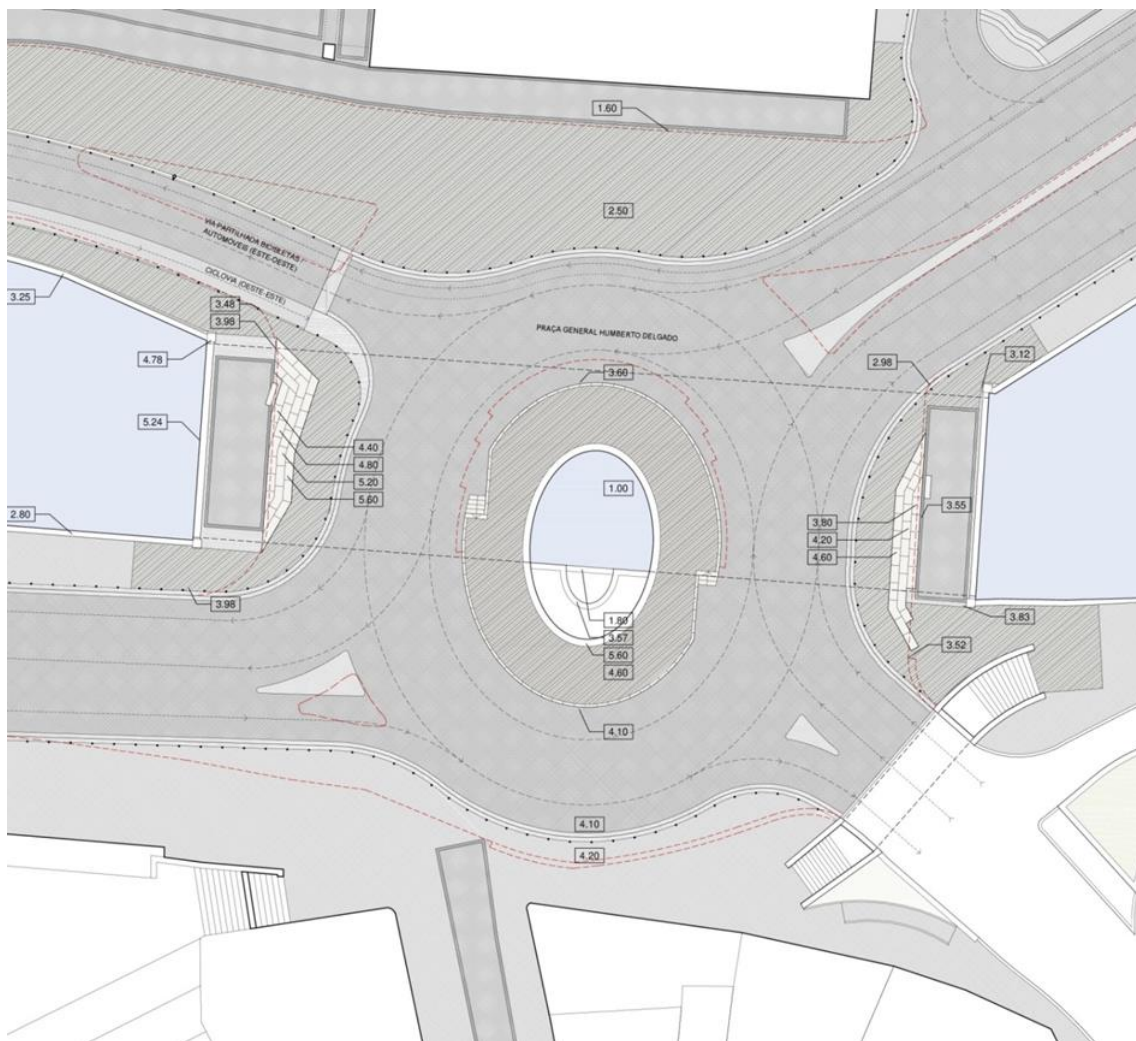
Planta da proposta para intervenção na Ponte-Praça
